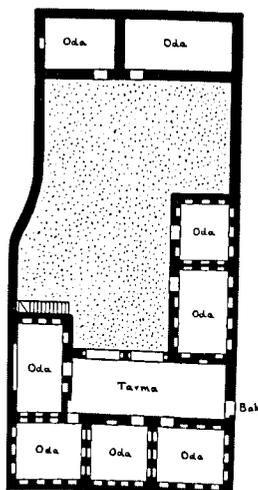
Haus des Hussein el Ali. Koweiresch. Grundriß.
